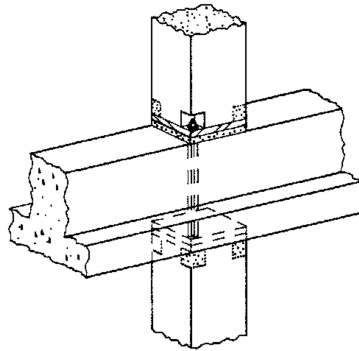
Exemplo de ligação viga-pilar com interrupção de pilar e varão roscado. Adaptado de [6].
